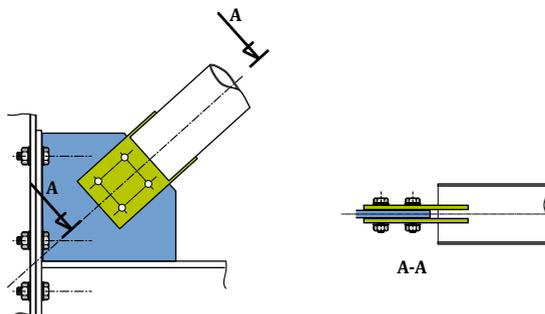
Assemblage par double plat enfourché pour une diagonale à section creuse circulaire
